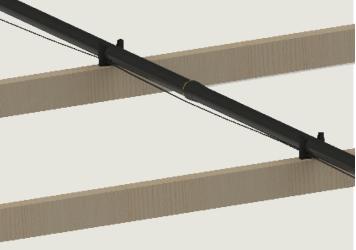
La abrazadera para tubería Allaway soporta las tuberías. Los cables de baja tensión que se instalan junto a las tuberías se han tenido en cuenta en las abrazaderas para tubería.
